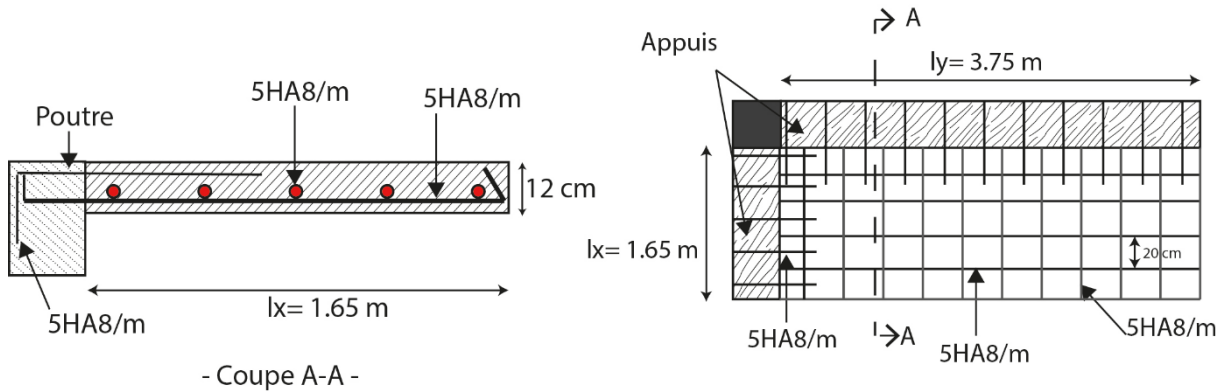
Schéma de ferrailage de la dalle sur 2 appuis.
